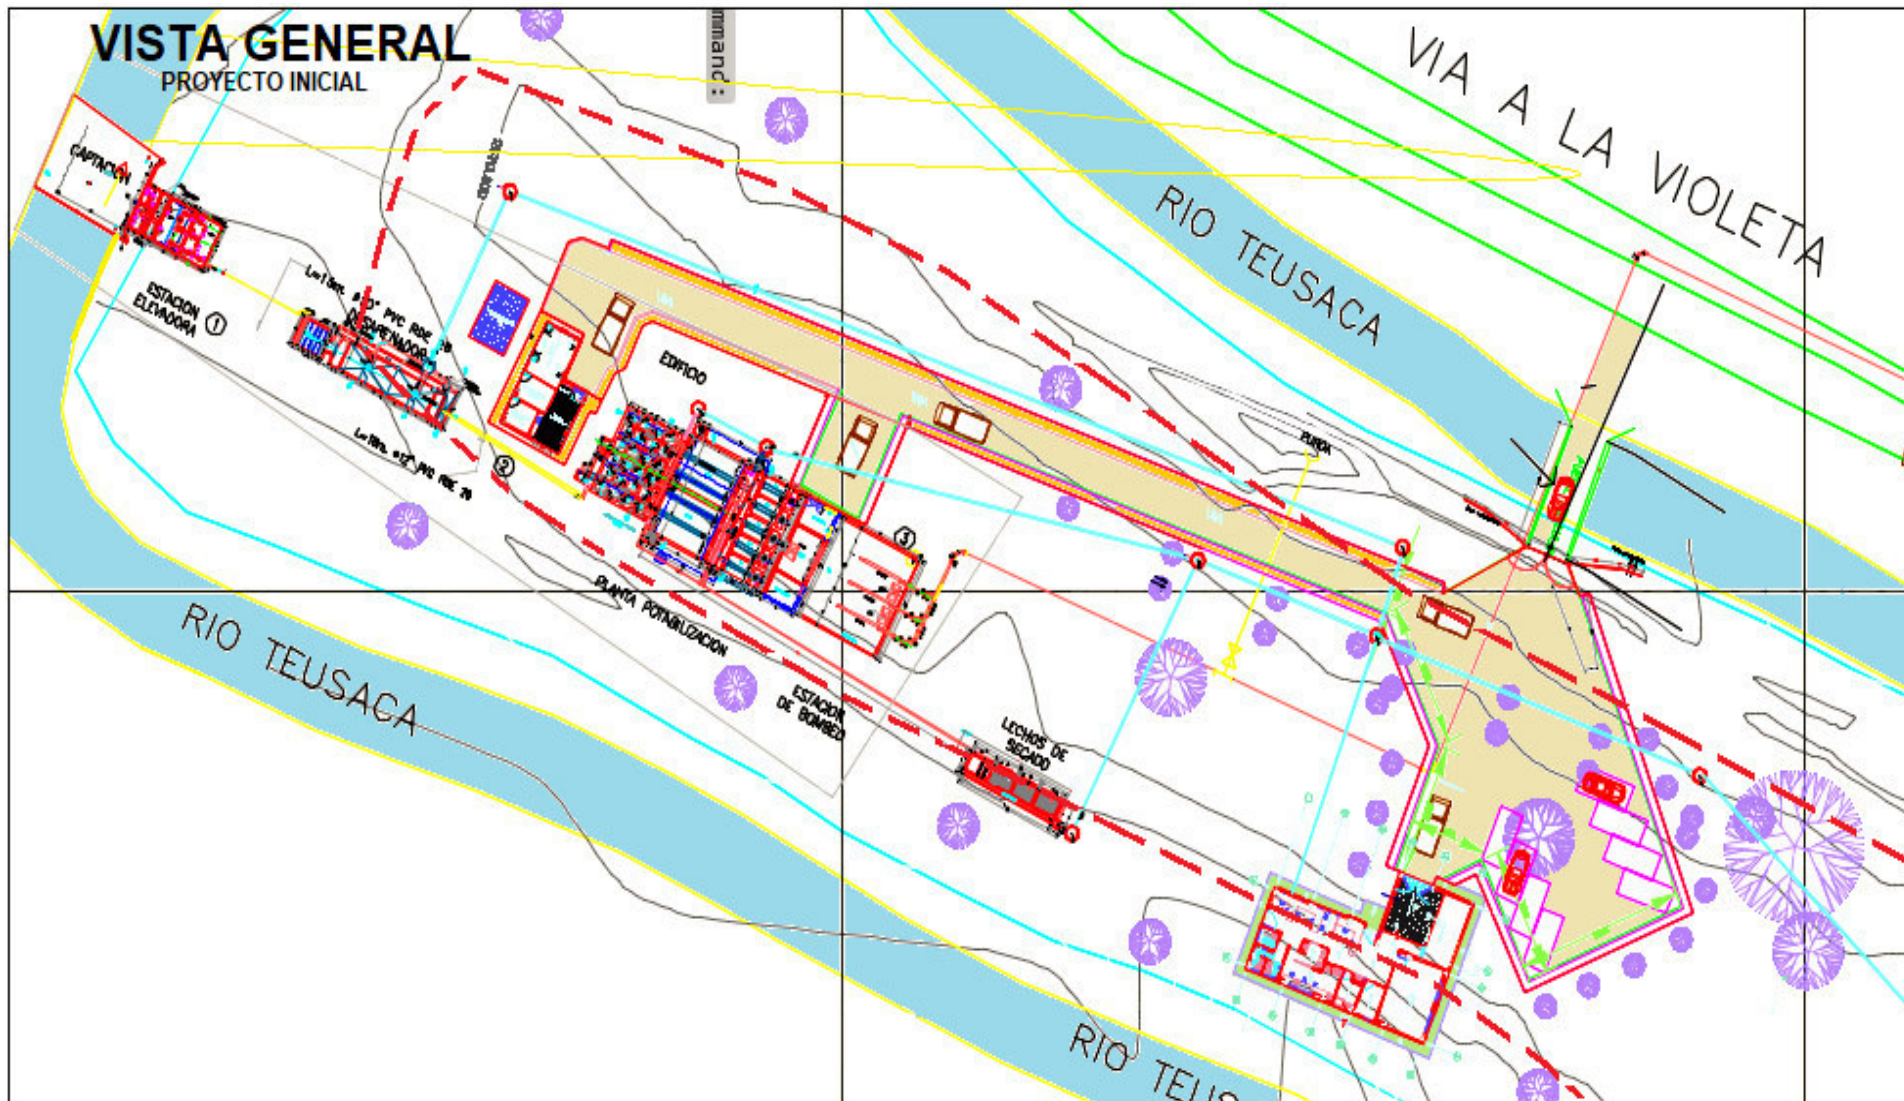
Plano en planta de la implantación del proyecto de la PTAP.
